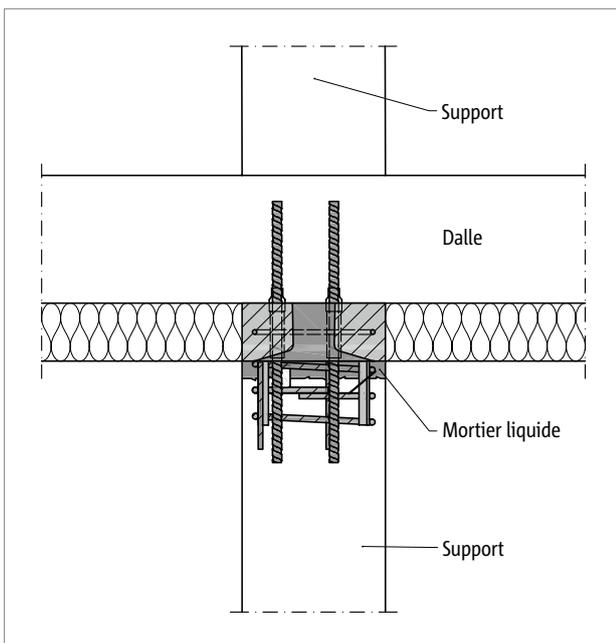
Schöck Sconnex® type P : raccordement d'un poteau interne à la dalle sus-jacente
